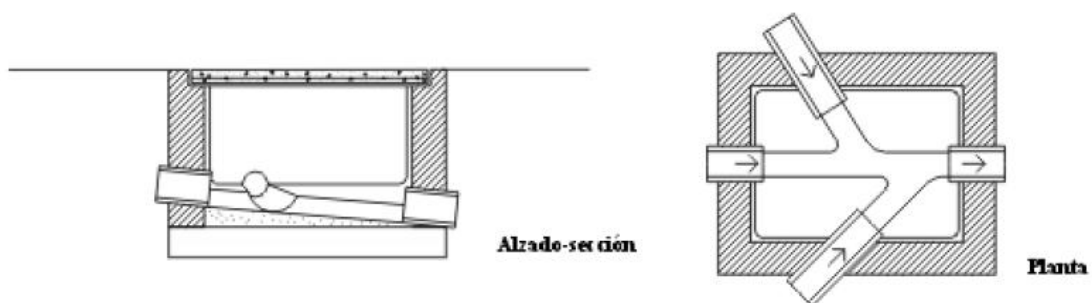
Vista de sección y planta de la conexión de colectores enterrados.
